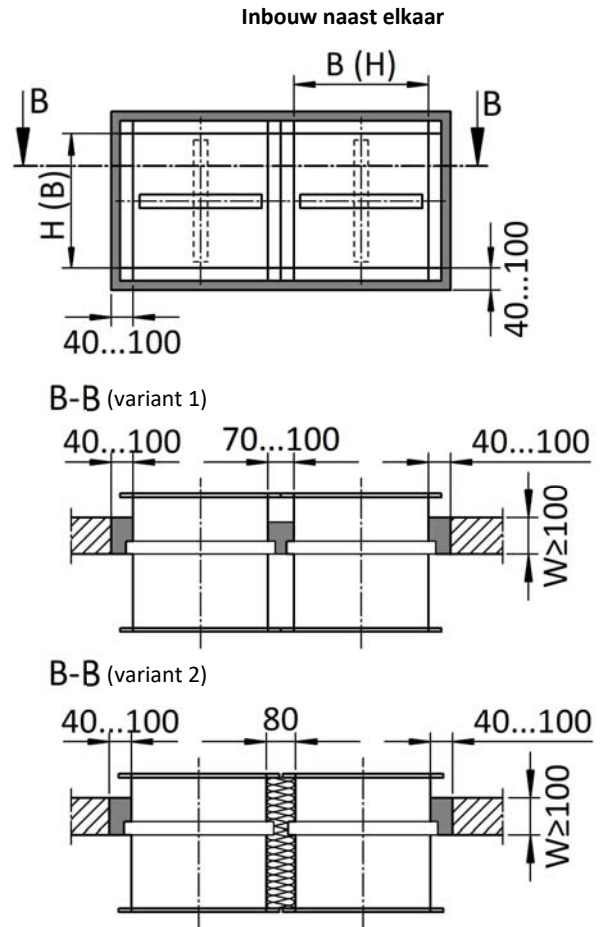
ringopeningsafmetingen volledige uitmorteling in massieve muren
